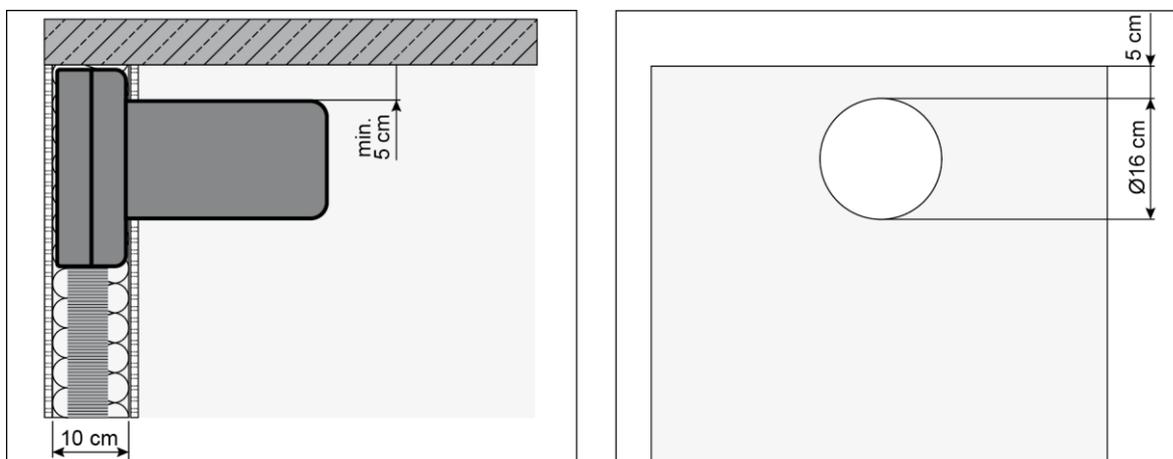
Montage in Trockenbauwänden, Seiten- und Frontansicht
